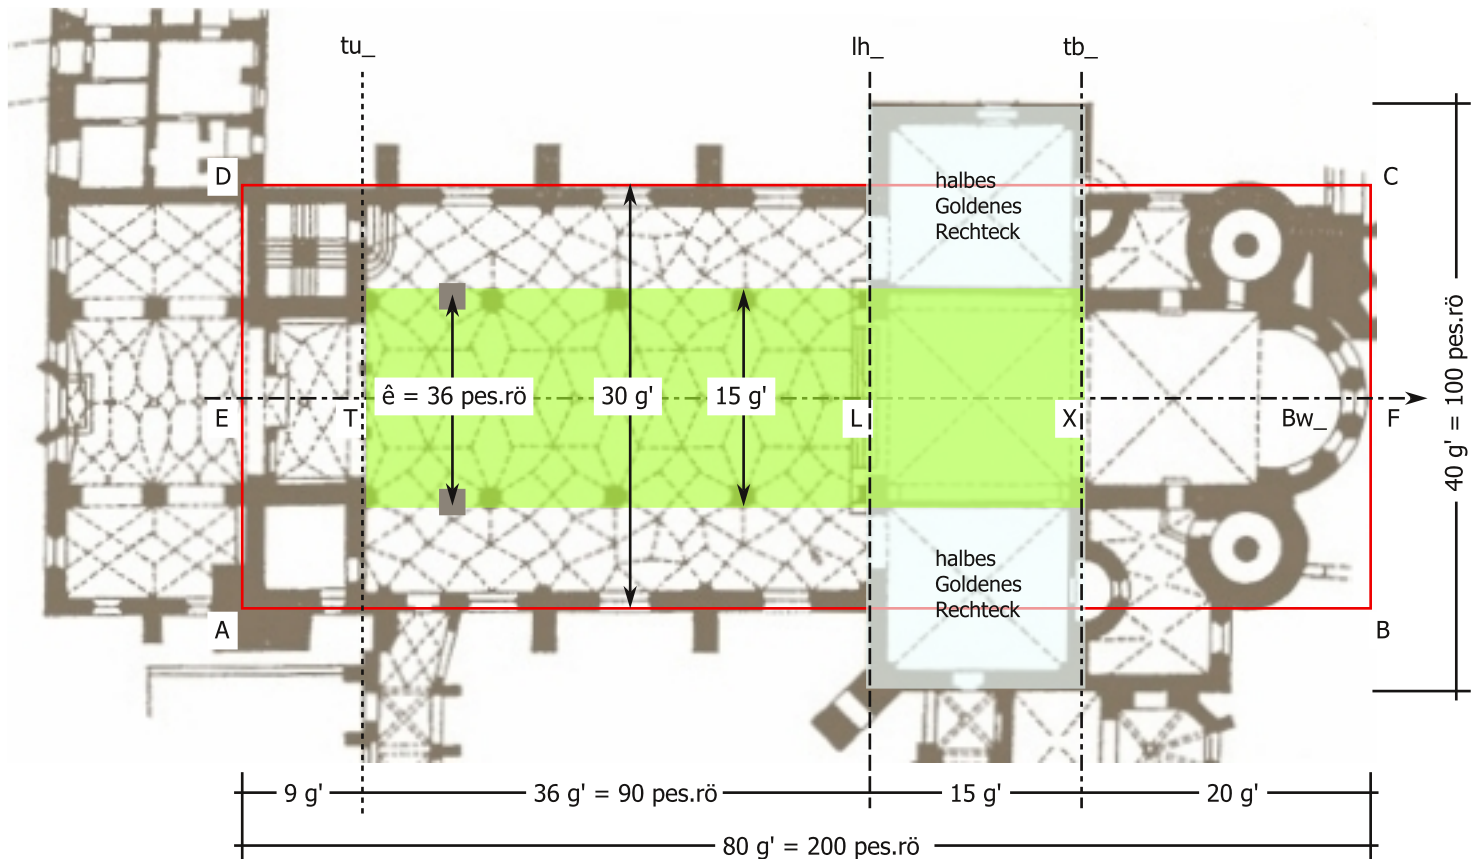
Grundrechteck und dessen Raumbereiche mit den entworfenen Längen und Breiten auf dem Grundriß des Merseburger Doms.
